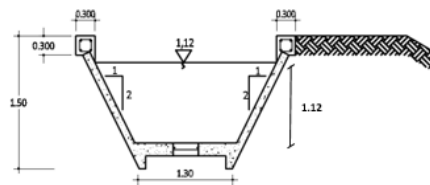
Detail Saluran Sekunder (SJ 3)
